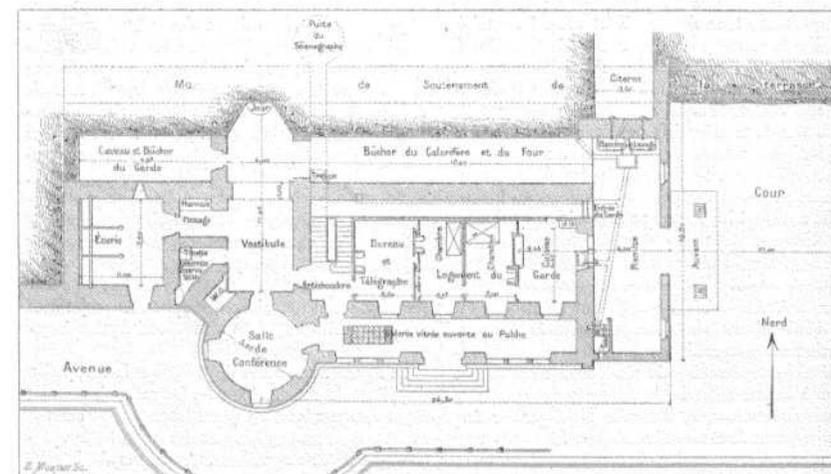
Plan de l'Observatoire. — Rez-de-Chaussée.
